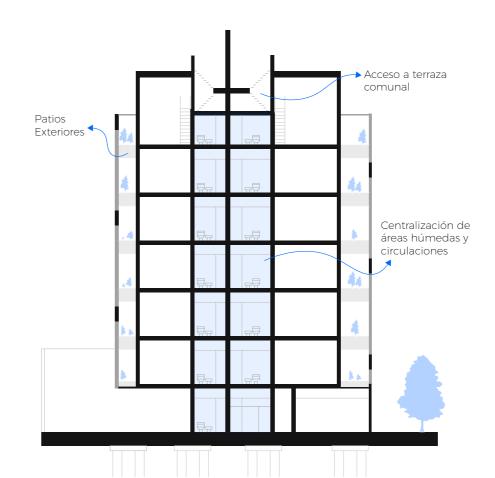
Sección longitudinal edificio Bonpland. Fuente: Elaboración propia basado en revista PLOT (2018)
